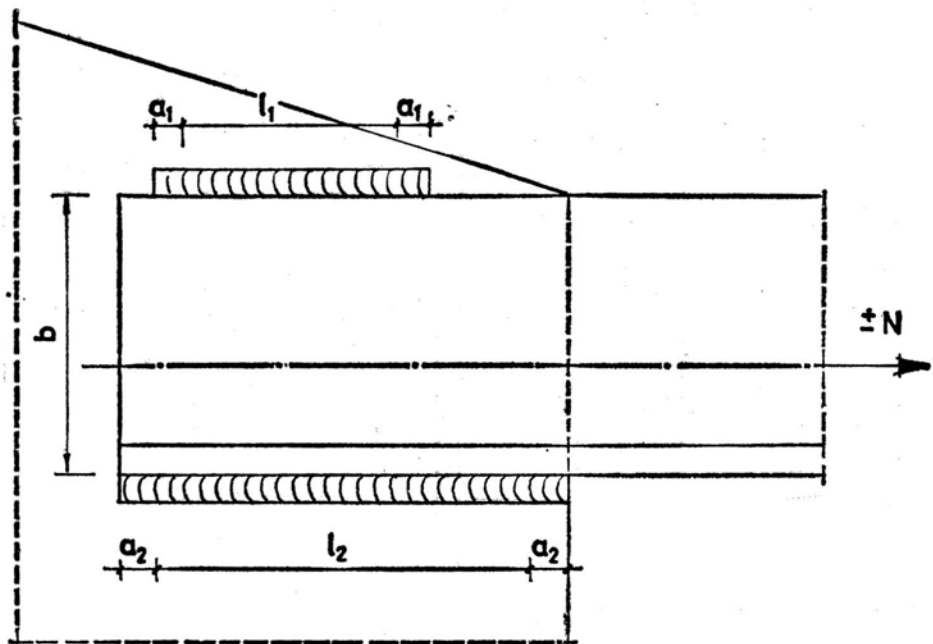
SOLDADURAS EN ANGULO EN LA UNION DE UNA BARRA QUE TRANSMITE UN ESFUERZO AXIAL.
